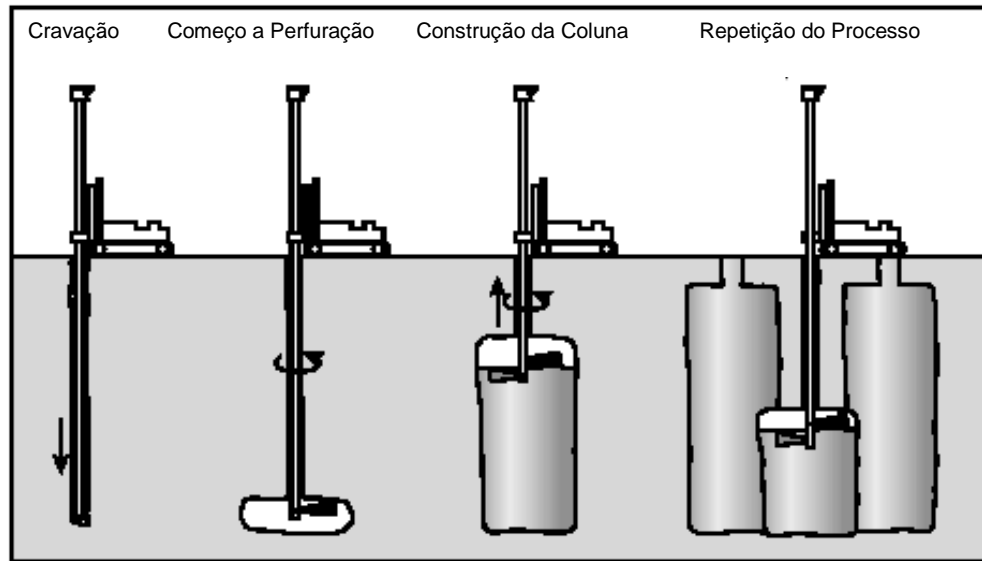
Croqui com as Etapas Construtivas do Processo de Construção das Colunas de "Jet Grouting" - (Fonte: HUSSIN, 2006)
